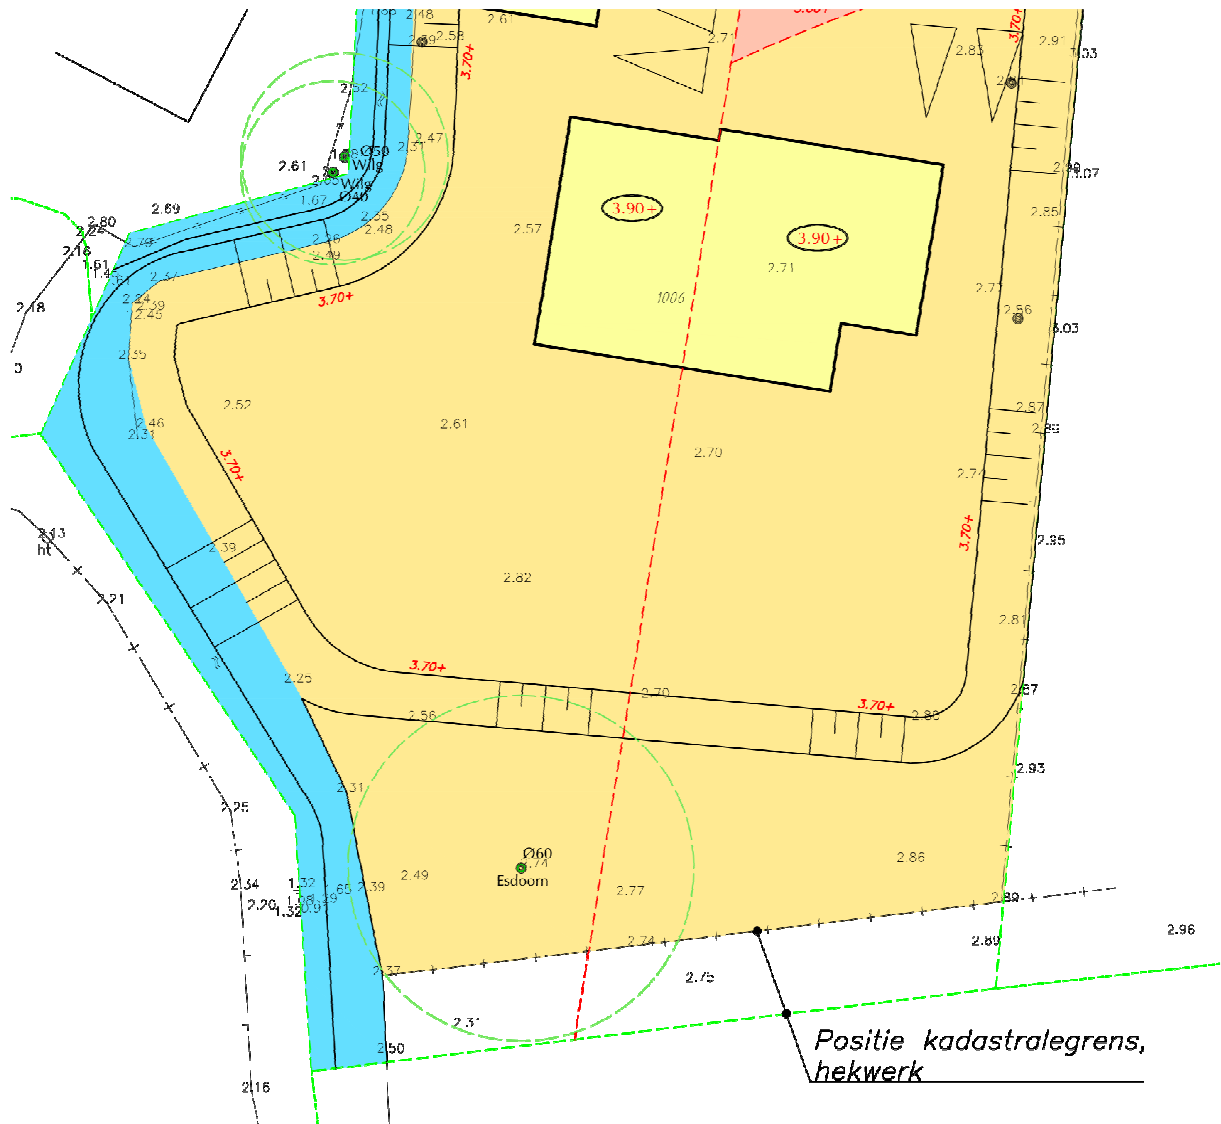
Bouwplan en peilen centrale deel plangebied.
